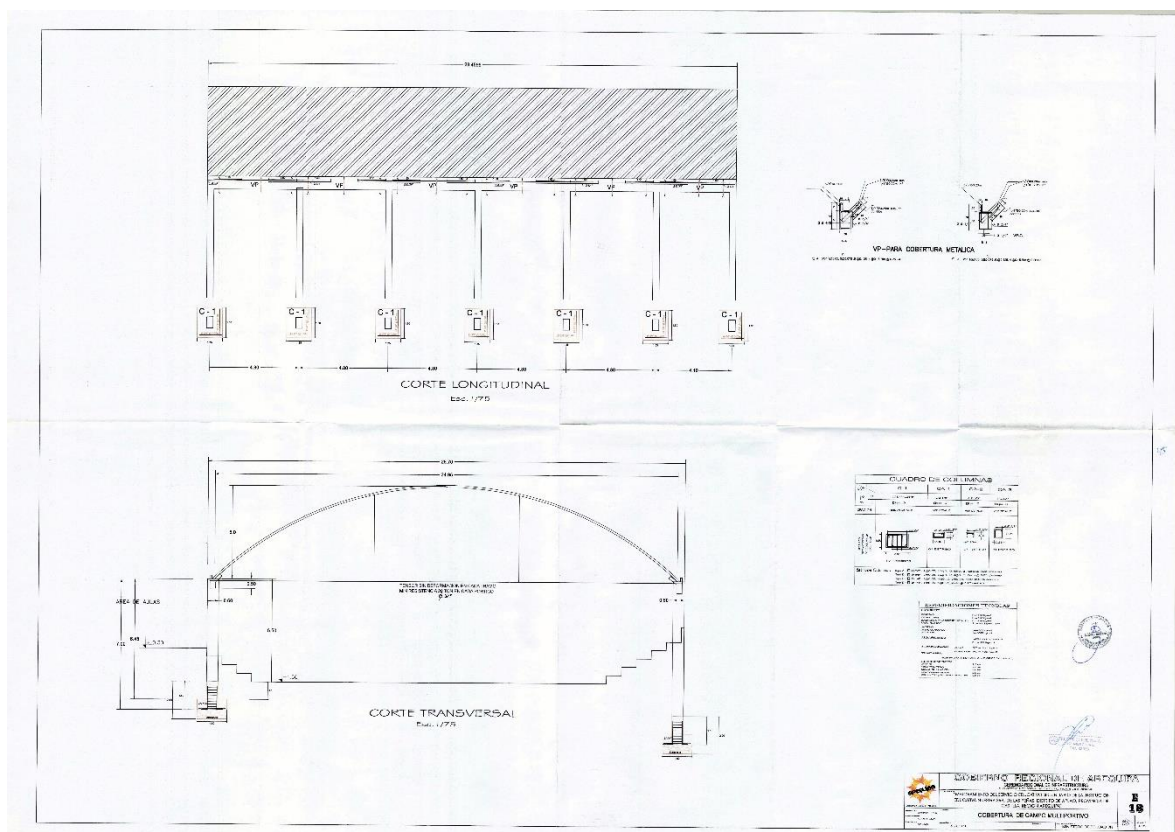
Plano de detalles para la cobertura metálica autoportante del expediente técnico aprobado.
